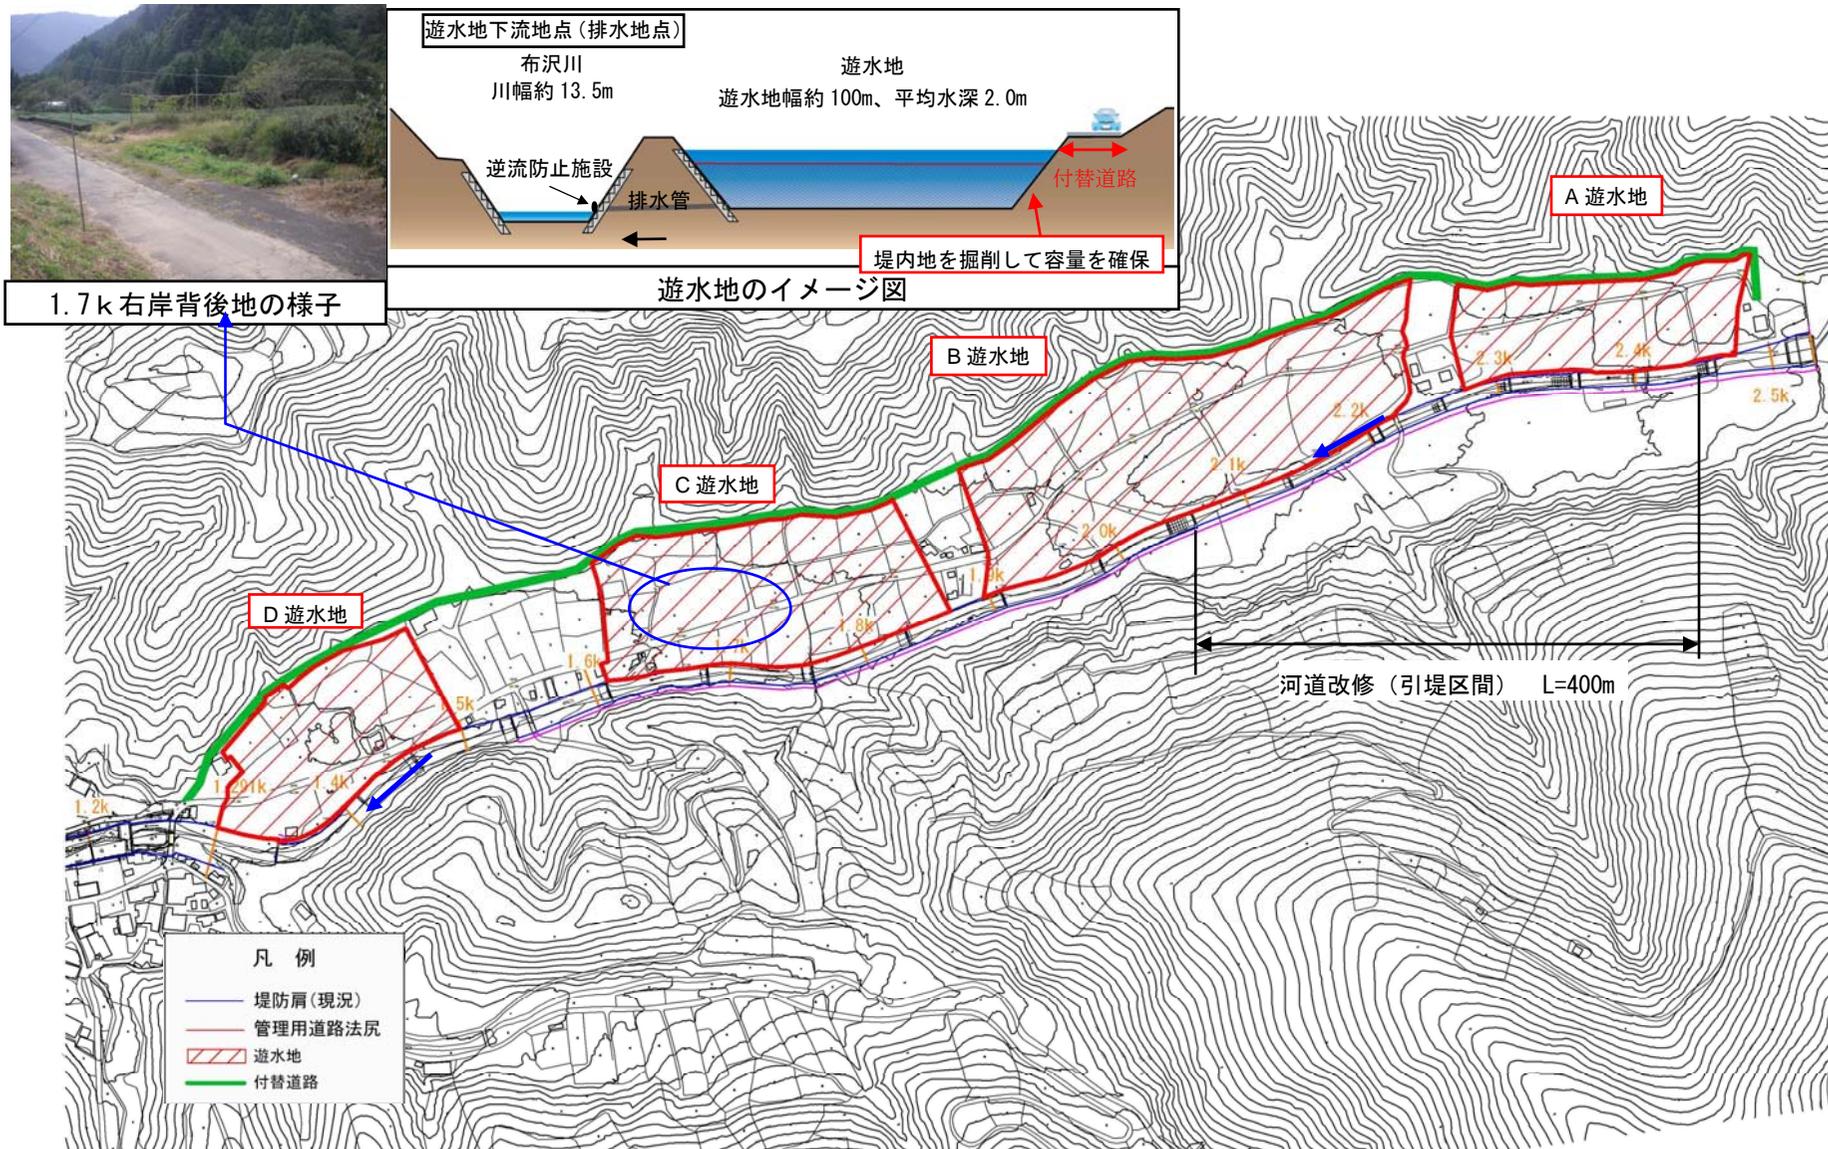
遊水地+河道改修案の計画平面図 (上流区間)
